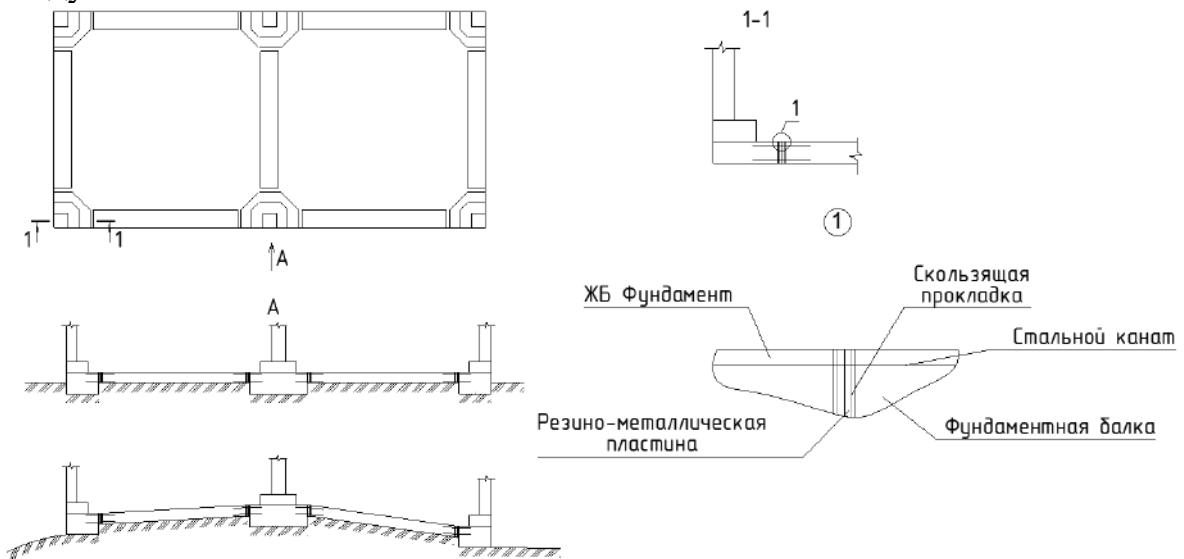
Конструкция предлагаемого адаптивного фундамента
